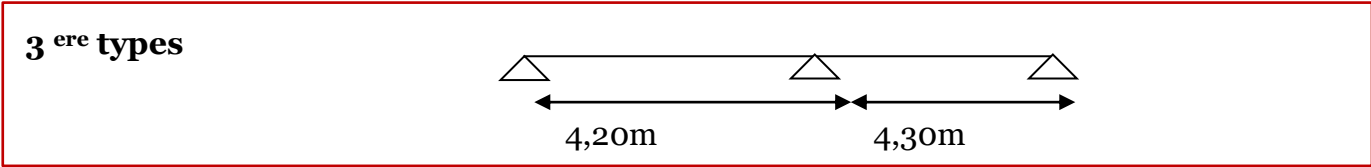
Les types des poutrelles (terrasse et étages courants).
